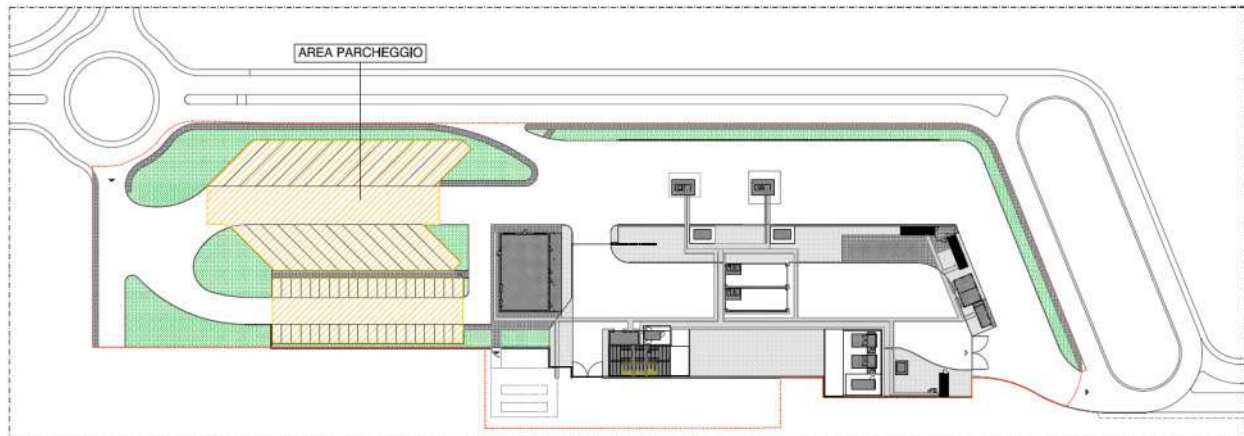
planimetria di progetto con indicata area destinata a parcheggio
